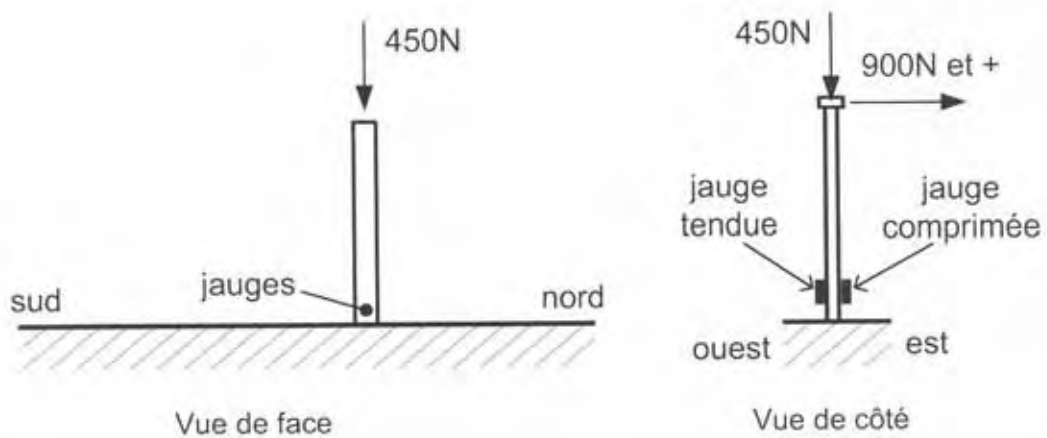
Essai statique sur un seul montant ancré au parapet.
